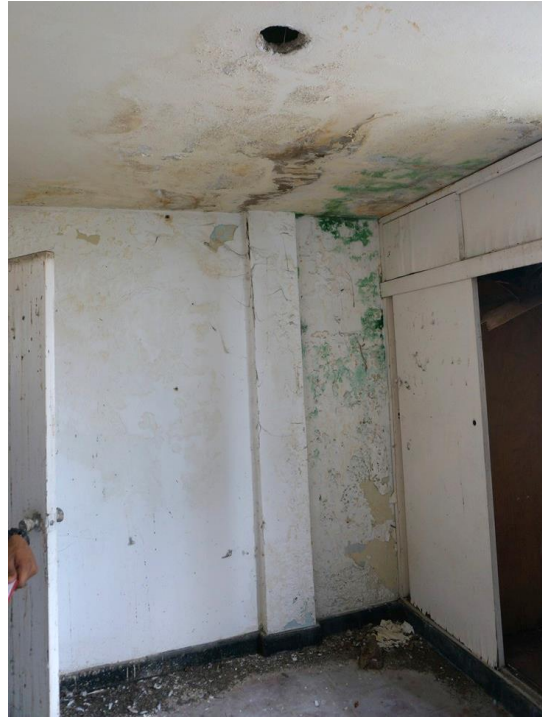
Detalle la cubierta y la zona inferior (cielo raso).
